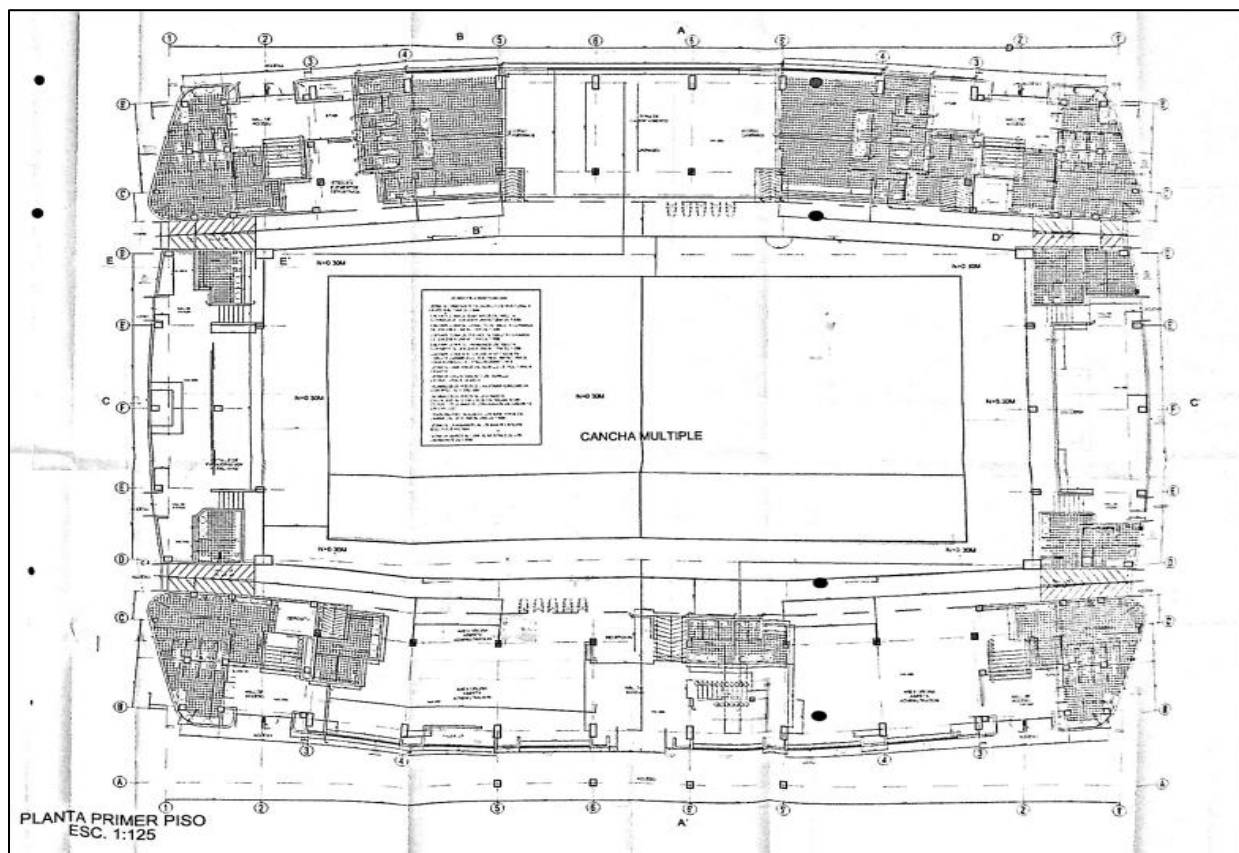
Planta General Primer Piso Coliseo León XIII.
